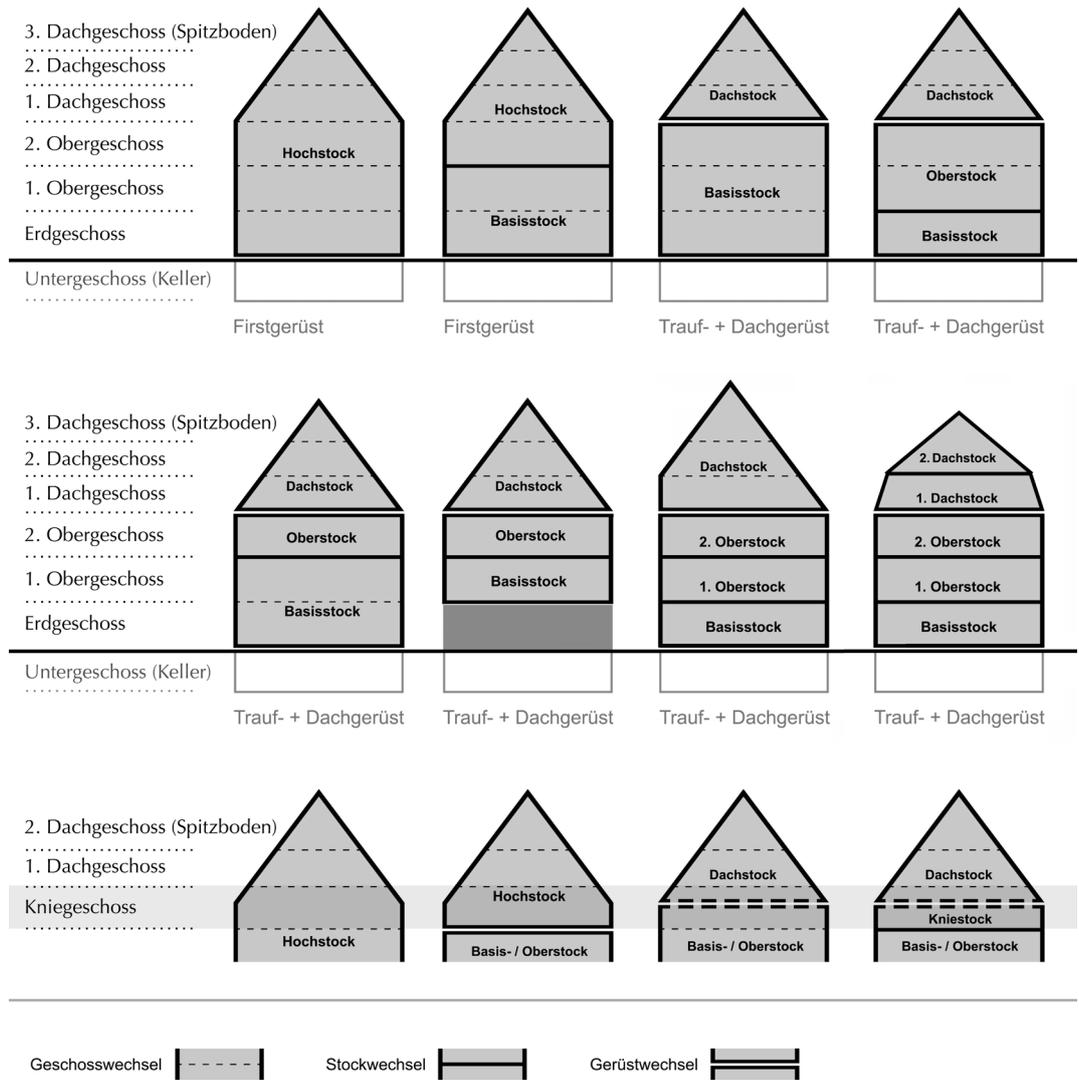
Hausgerüst mit Kniegeschoss (links) und mit Kniestock (rechts).
